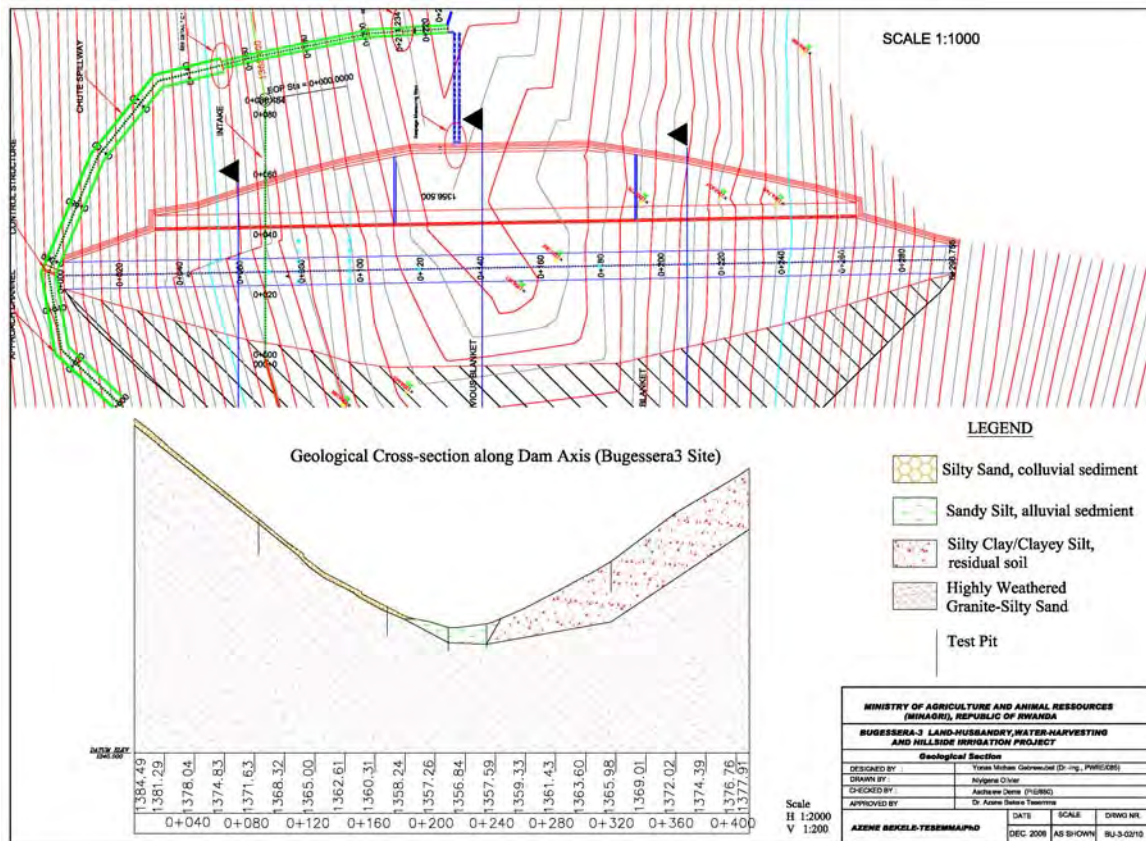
Section longitudinale et plan de l'axe de barrage (Rapport de conception LWH)
